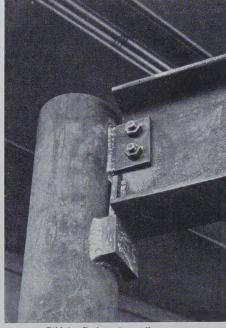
Deckenträgerauflagerung an der Fassadenstütze mit angeschweißter Knagge (Versuchsstück)
